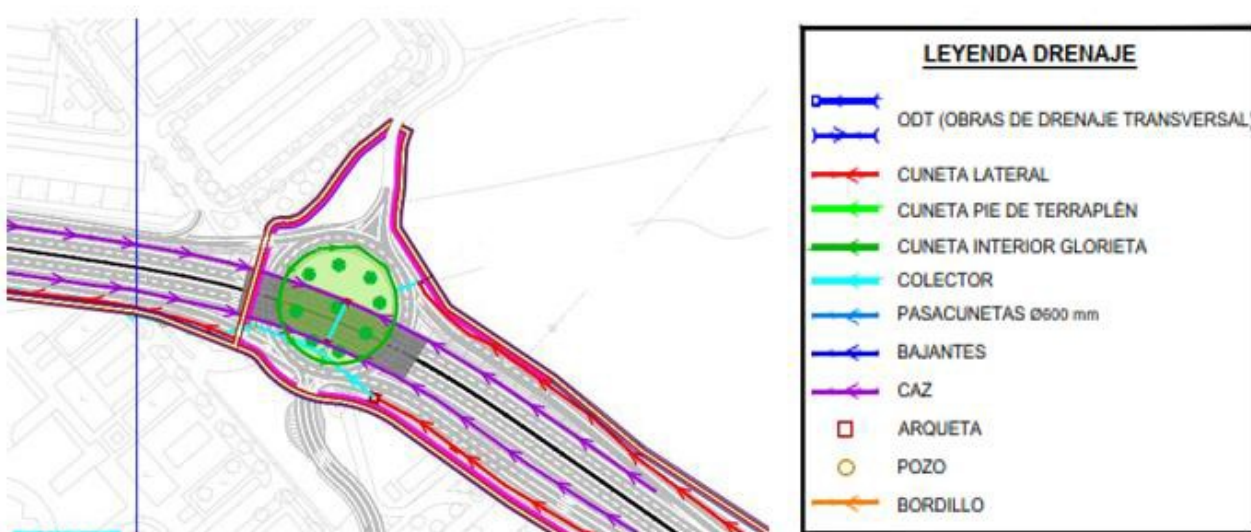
Esquema red de drenaje en zona paso inferior (Hojas 01 Y 02 planos drenaje, Alternativas 1 a 4).
